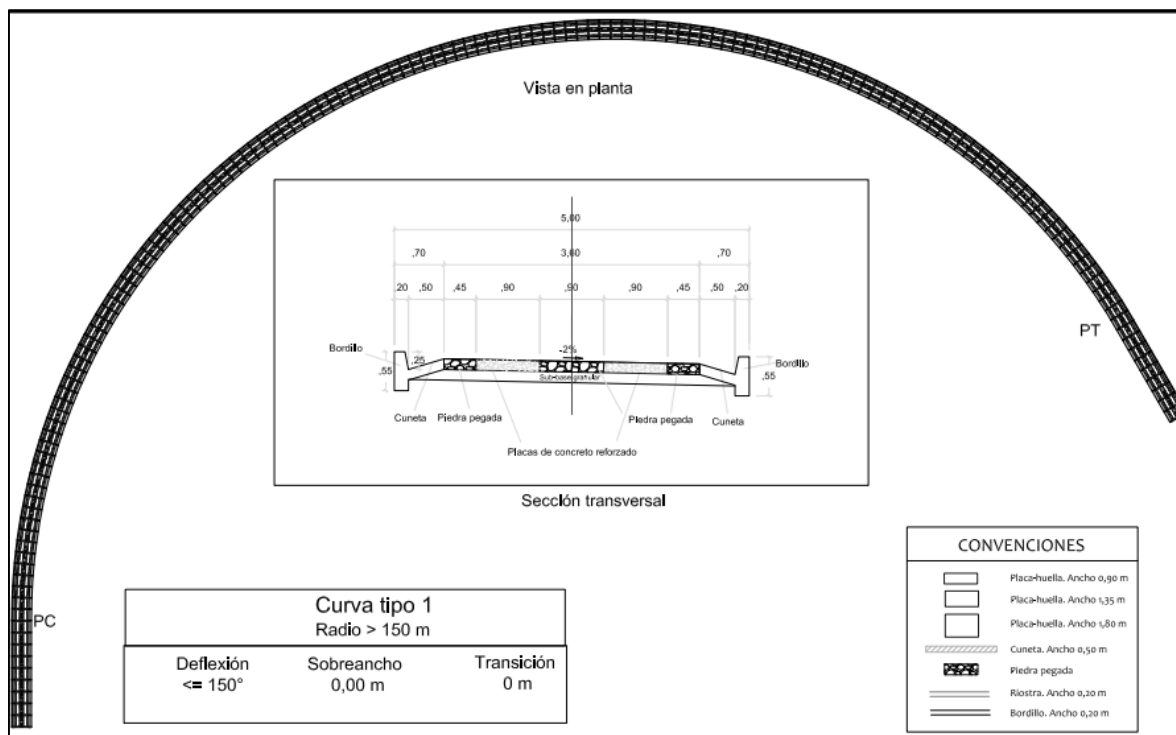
Diseño estructural con corte transversal y vista en planta para el octavo tramo curva 4.
